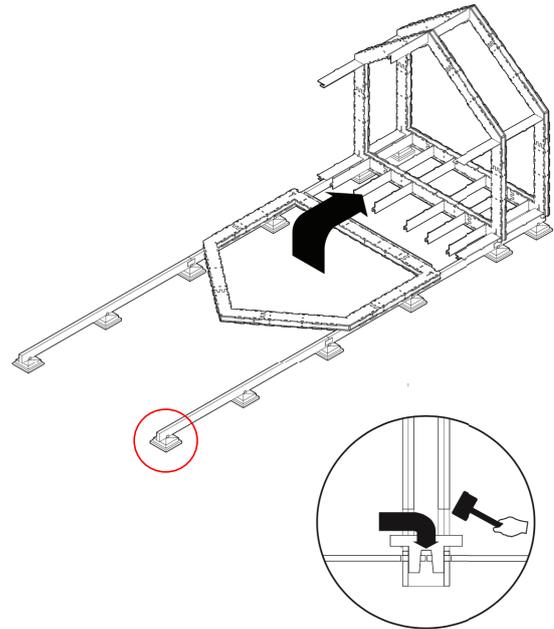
fundação no caso WikiHouse; acima, é mostrado com ela foi pensada para a Microhouse; as sapatas podem ser feitas de metal, que não somente de concreto armado, e apoiadas na superfície. Fonte: caderno de encargos Microhouse / Fundação WikiHouse
